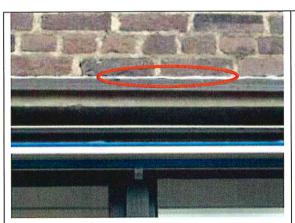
Fog som bedömts att det föreligger risk att innehålla PCB.
